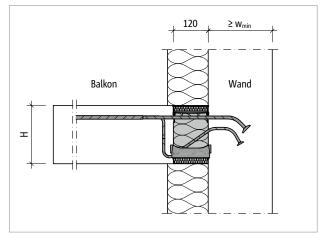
Schöck Isokorb® XT Typ K-O: Wandanschluss nach unten bei Außendämmung
